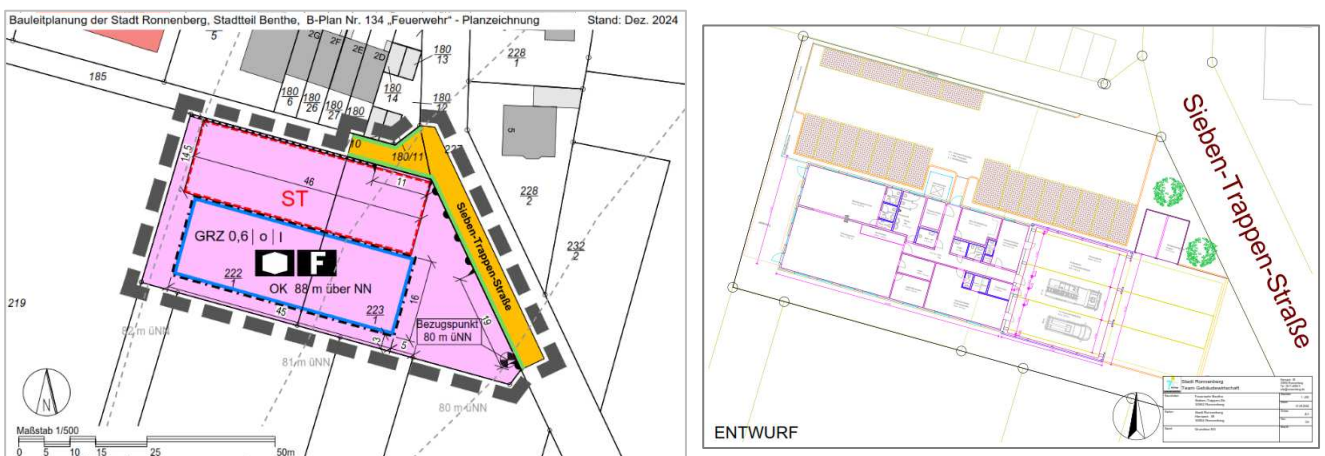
Bebauungsplan Nr. 134 (Entwurf) und Hochbau-Entwurf der Feuerwehr
